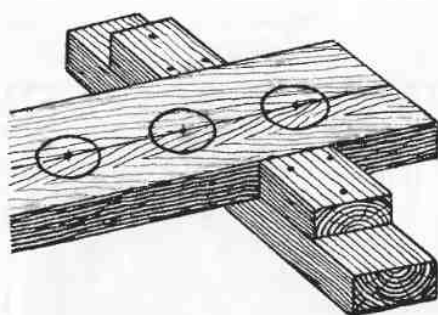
Подготовка досок охлупня для сверления в них полукругов с помощью кругореза.
